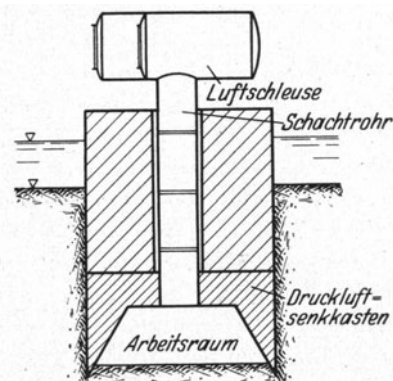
Schema einer Gründung mittels Druckluftsenkkastens.
